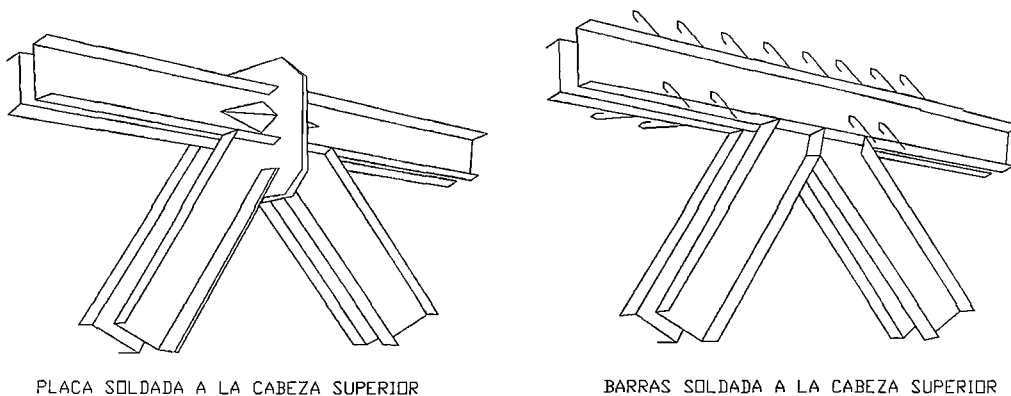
Detalle de Soldadura de las vigas del Puente de Tordera
